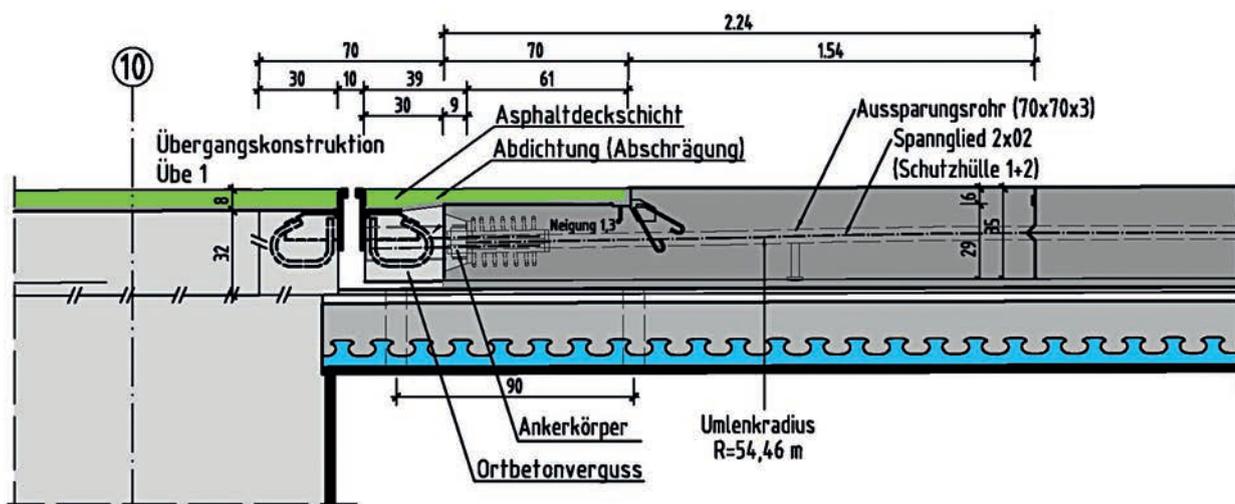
Übergang von der Asphaltfahrbahn auf die Betonsegmente im Bereich der Übergangskonstruktion (SSF Ingenieure)
